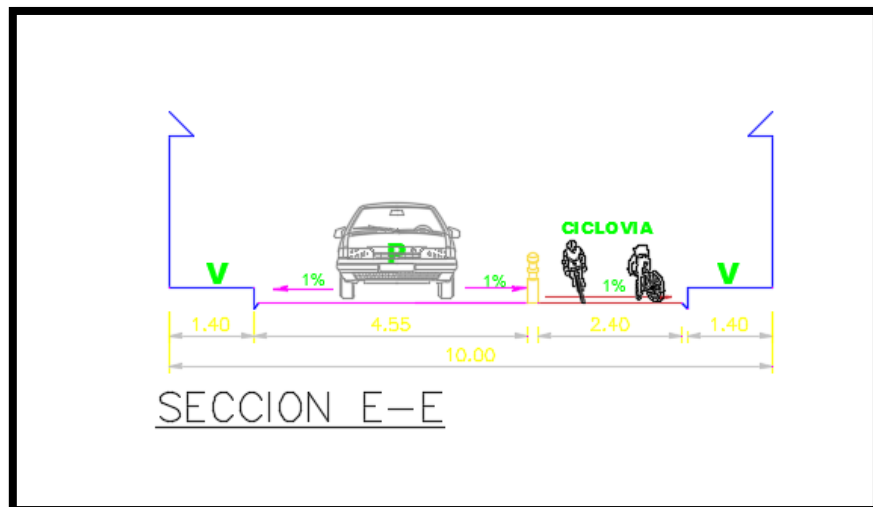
Corte Transversal de la Ciclovía, Sección E-E.
